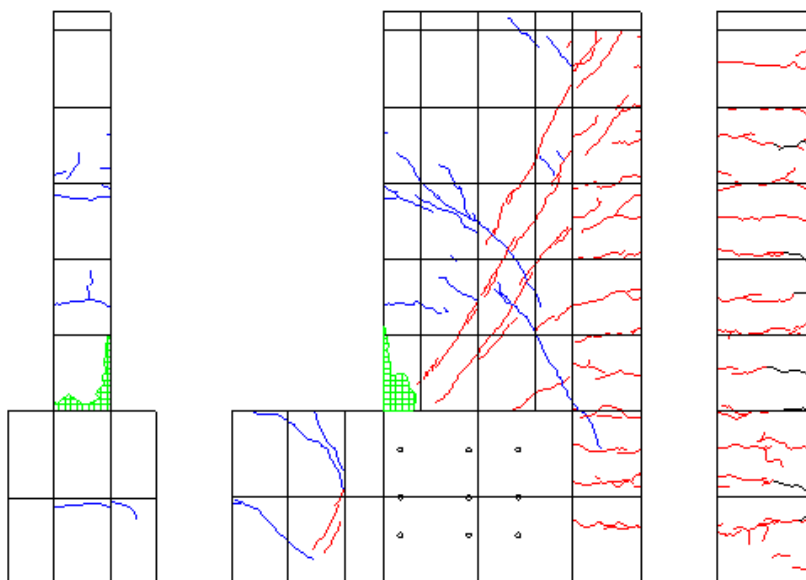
R=1/67 ひび割れ図
